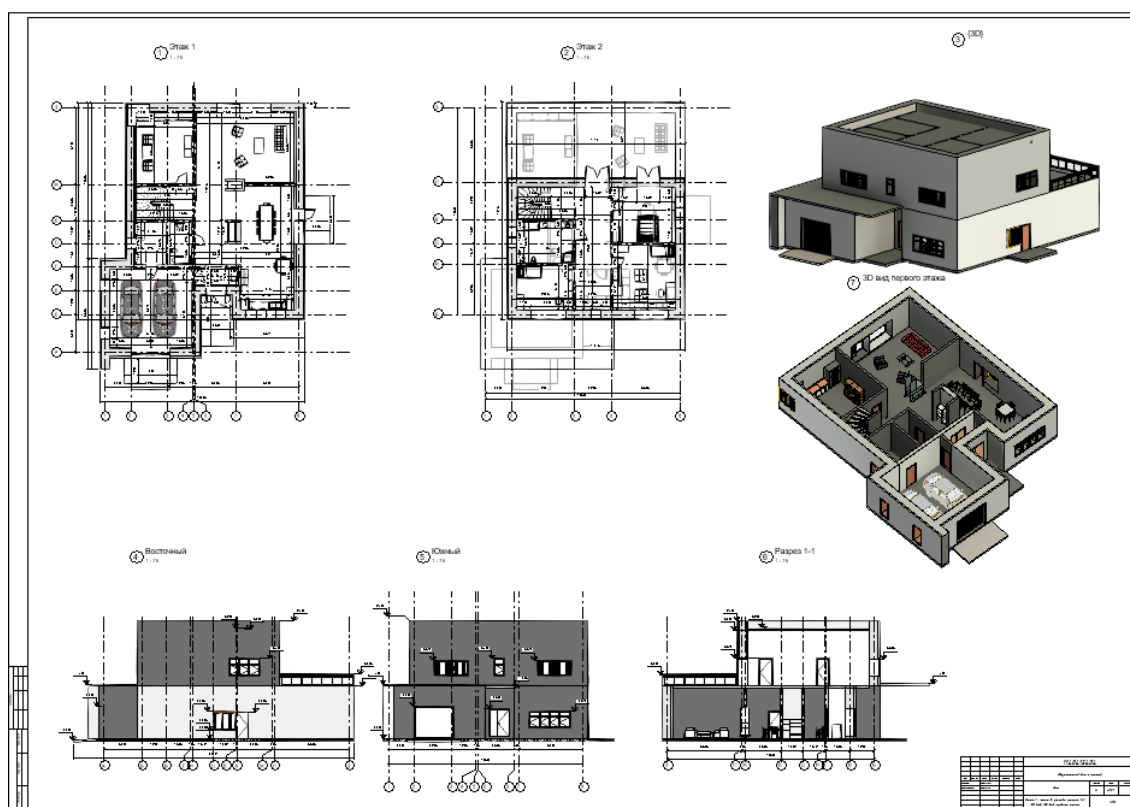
Лист. Планы, фасады, разрез, 3Dвиды
